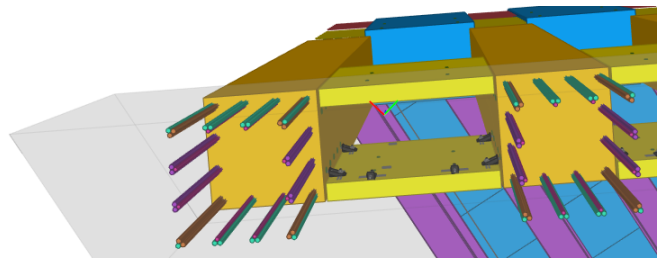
Vista del modelado de los pilares prefabricados con las barras de 32 mm de diámetro agrupadas en grupos de 3
